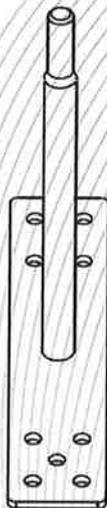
Anschlagereinrichtung, Typ: ES 300-800 FIRST gerade, mit gerader Grundplatte (60 x 280 mm)
